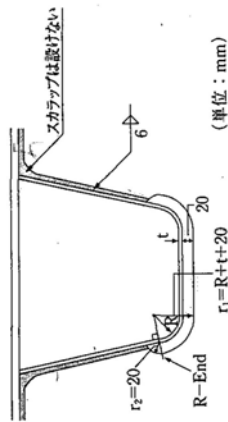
閉断面リブと中間横リブ又は横桁との交差部構造の標準
